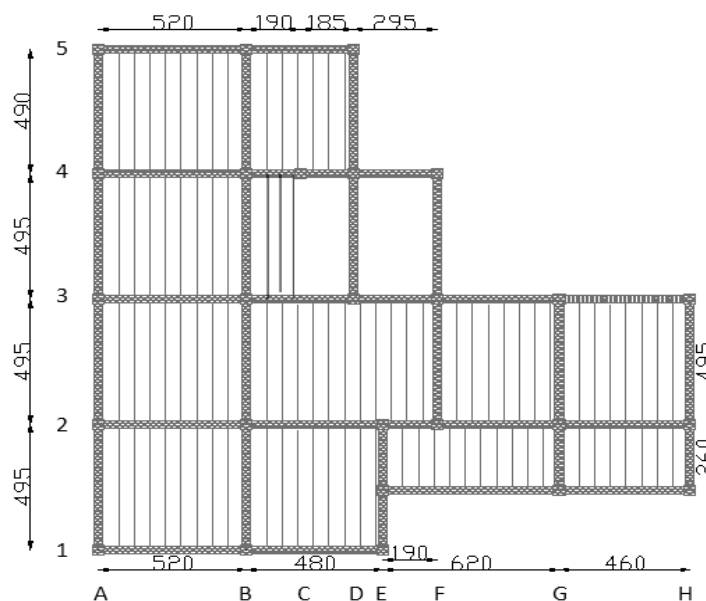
Vue en plan de la structure montrant la disposition des poutrelles
